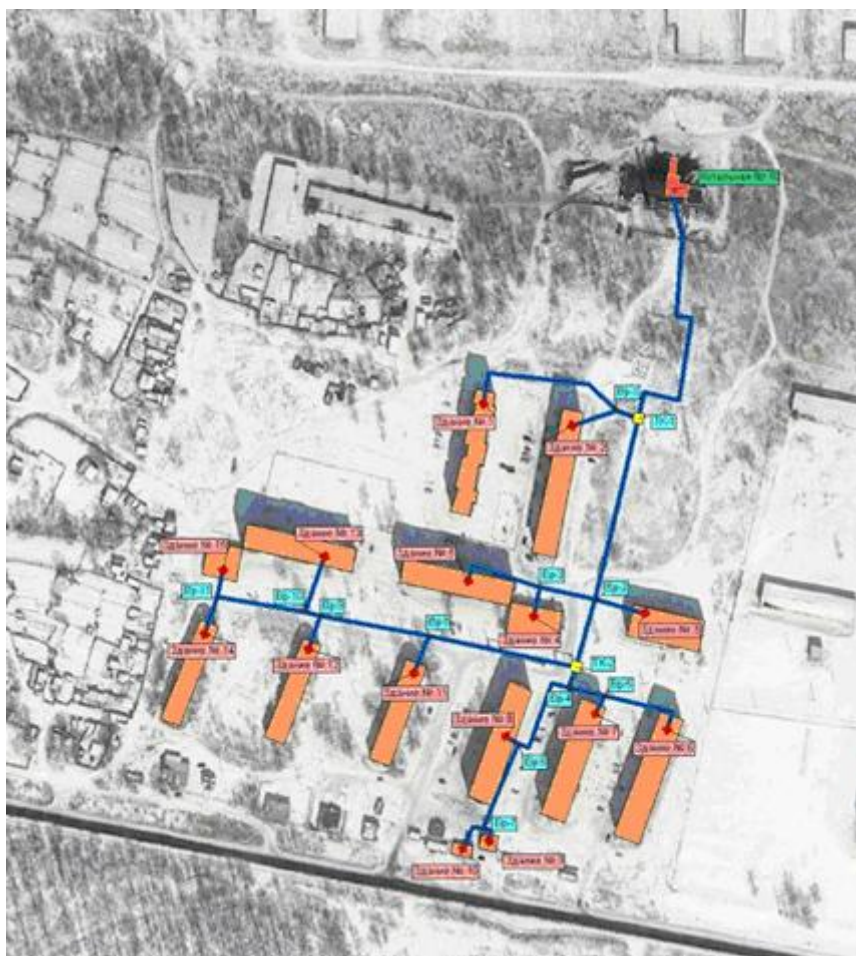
Схема тепловых сетей котельной в/г №2
